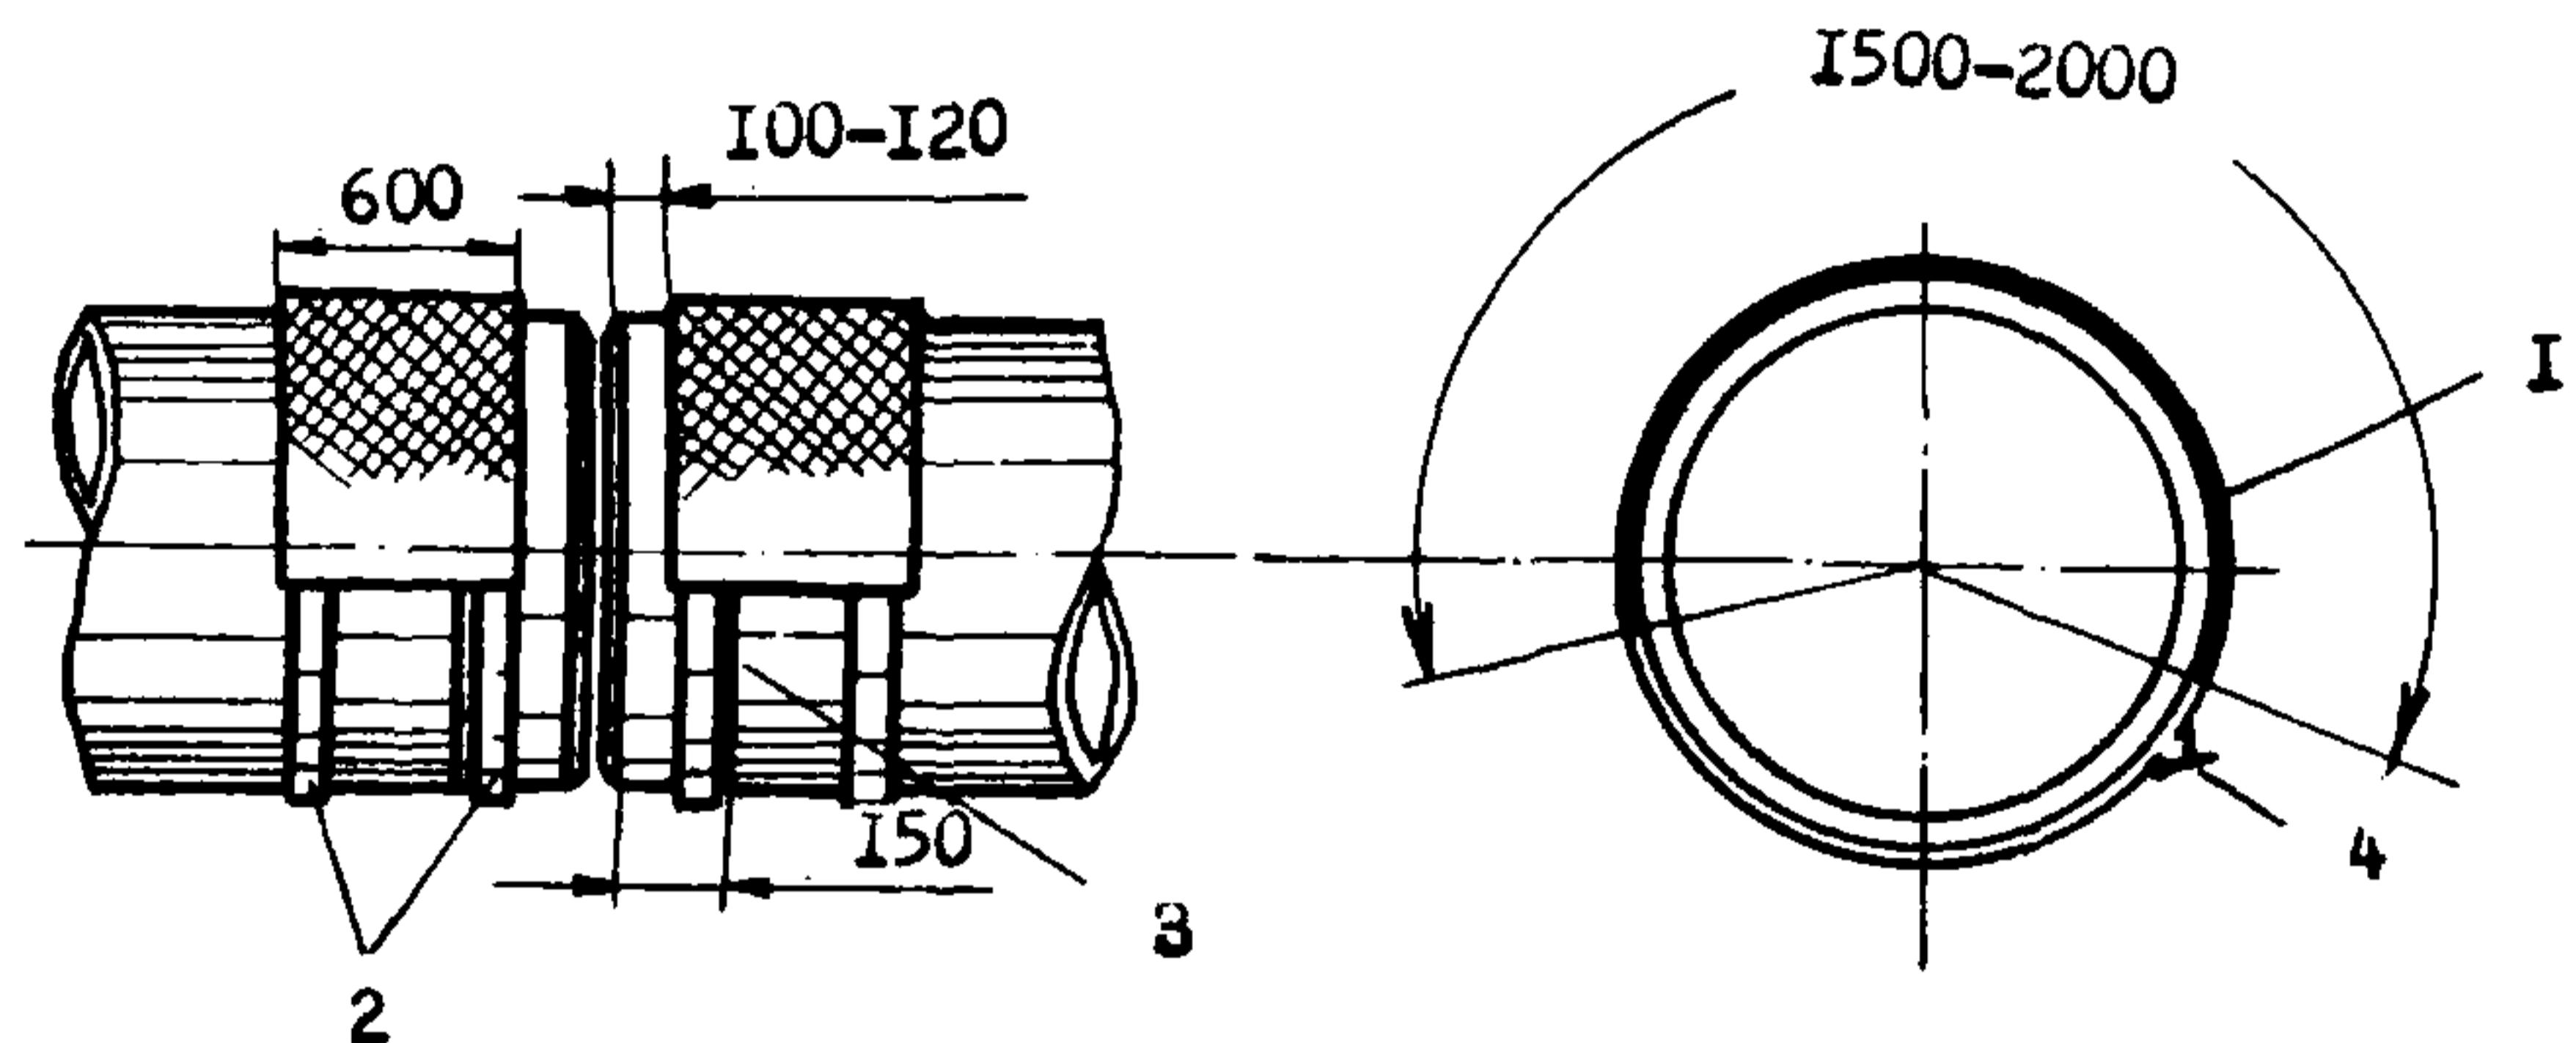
Защита изоляционного покрытия ковриком из асбестовой ткани при выполнении сварочно-монтажных работ:
